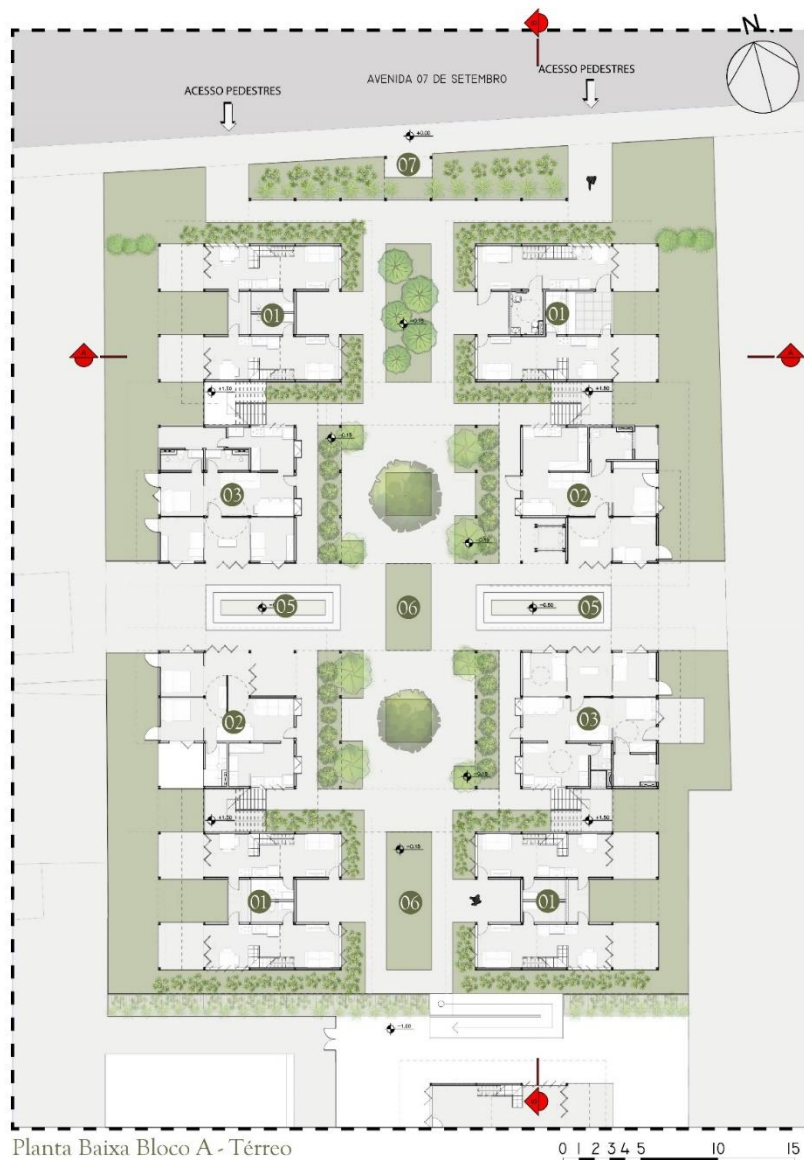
Planta Baixa Bloco A - Térreo. Fonte: Acervo do Autor.
